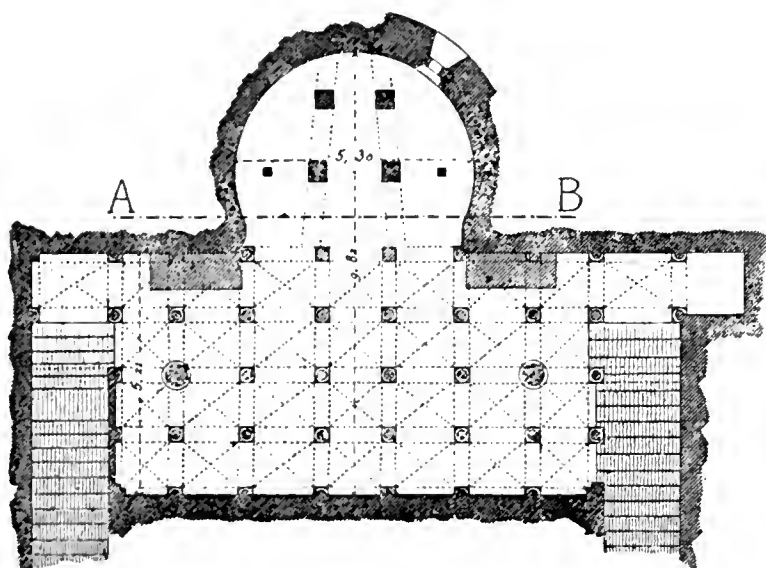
Plan de la Crypte de saint-Sauveur — Brescia — VIII^e et XII^e siècle.
